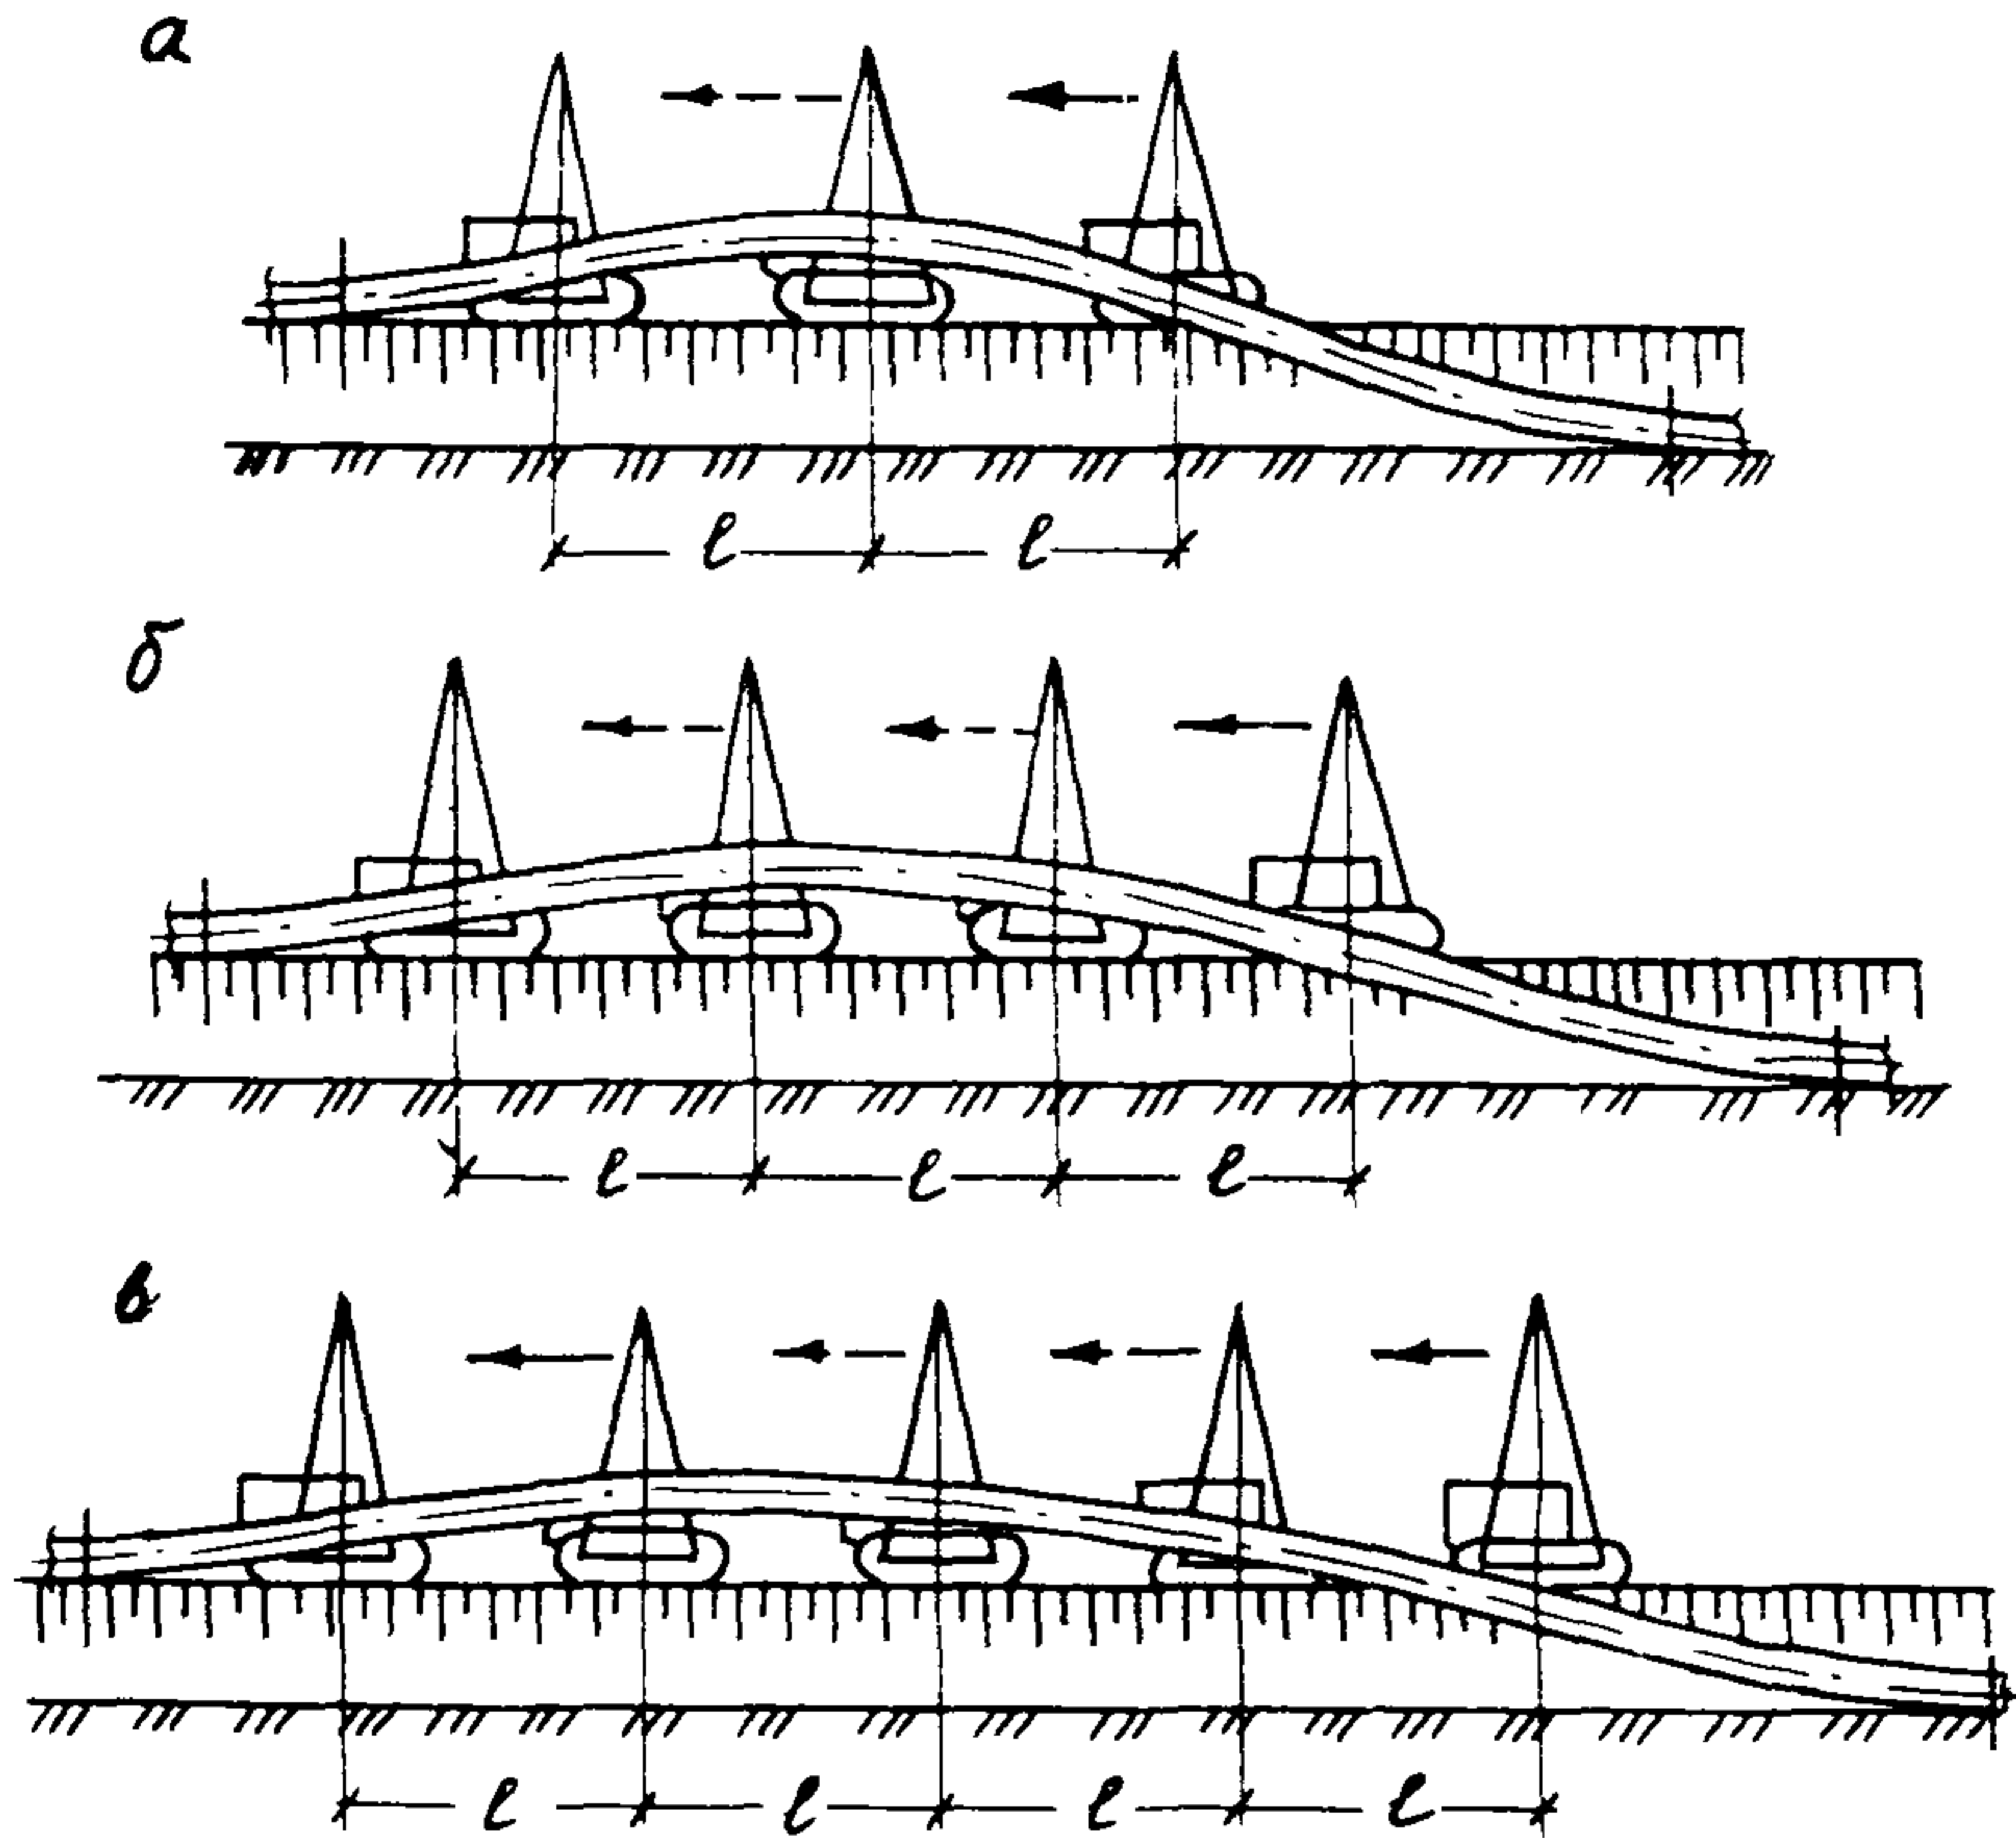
Технологические схемы укладки изолированного трубопровода циклическим методом при диаметре труб:
